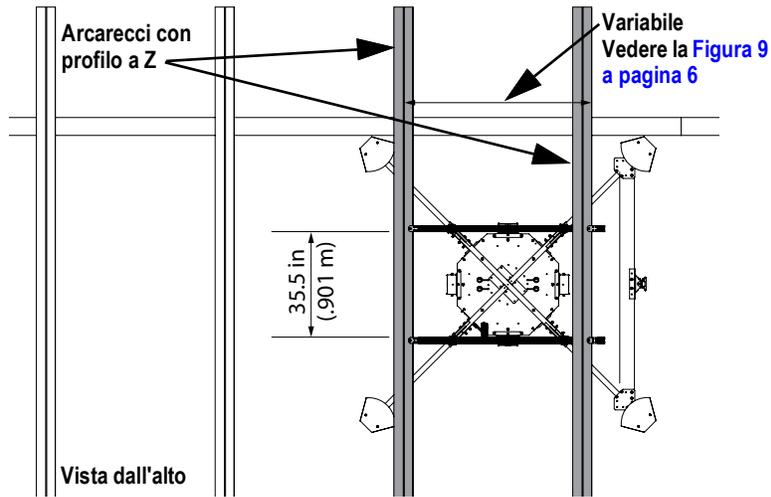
Vista dall'alto della configurazione ad arcarecci con profilo a Z
